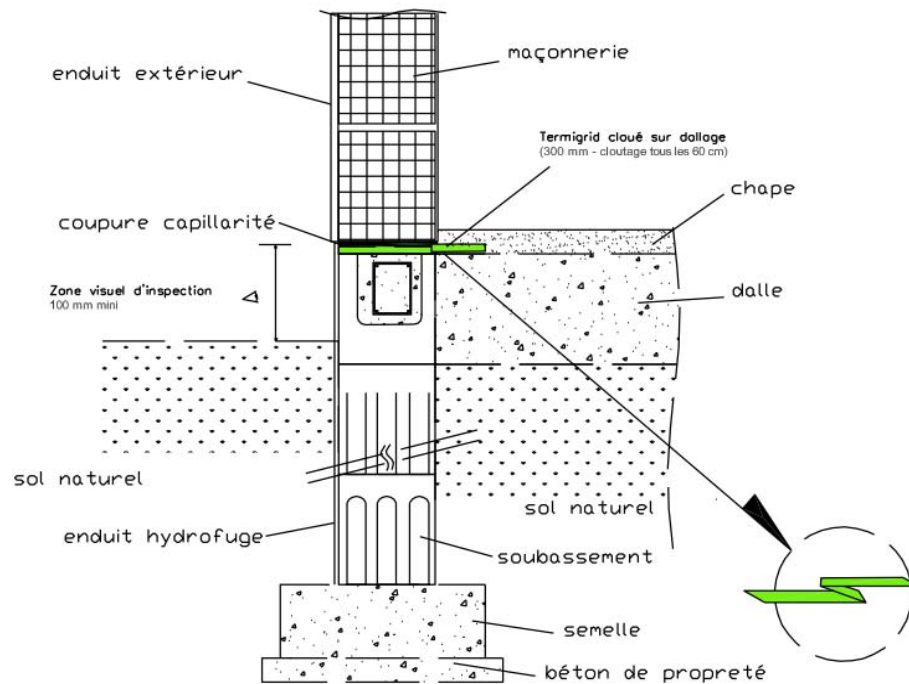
Coupes sur plancher bas constitué d'un plancher coulé sur terre plein.
